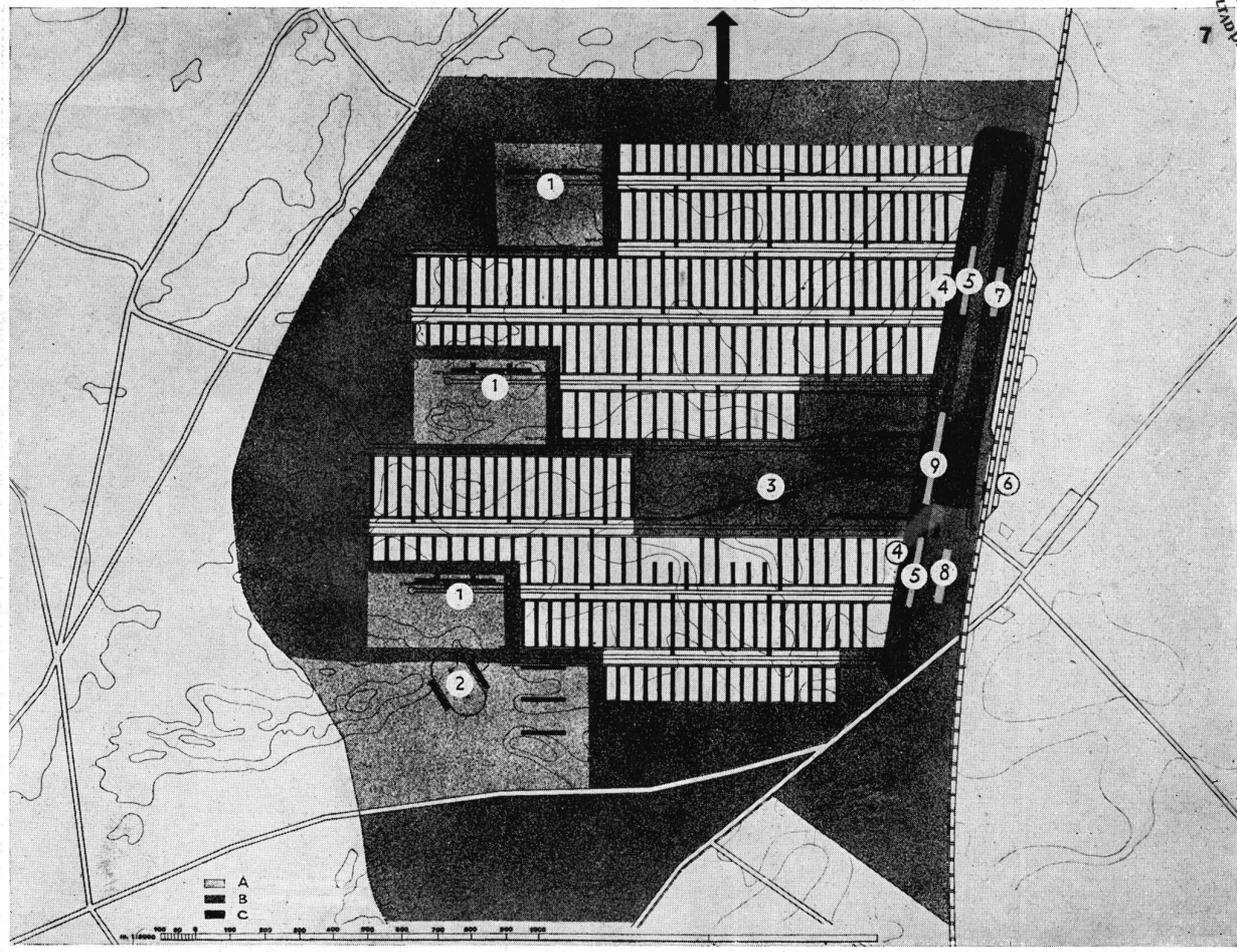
PLANO DE APROVECHAMIENTO DEL TERRENO II
